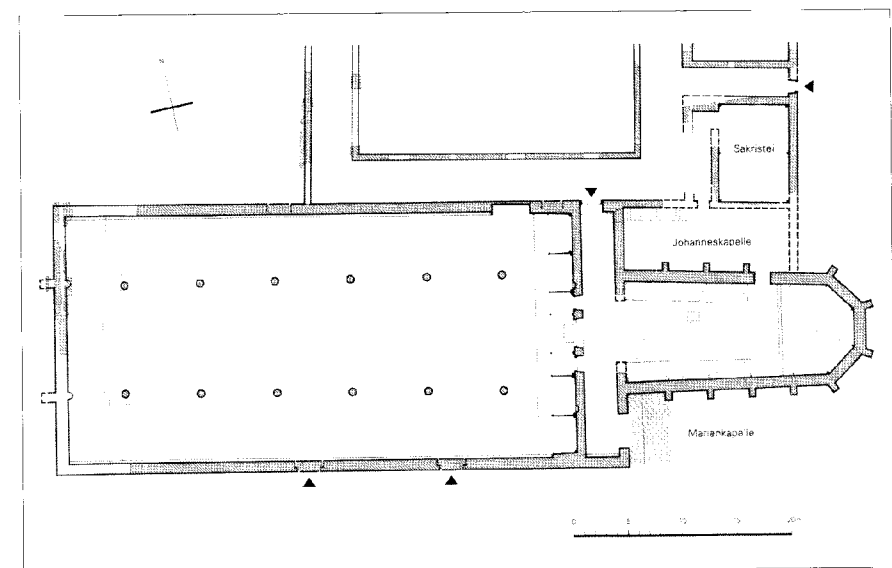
Bern, Predigerkirche (um 1310 fertiggestellt); Grundriss.
